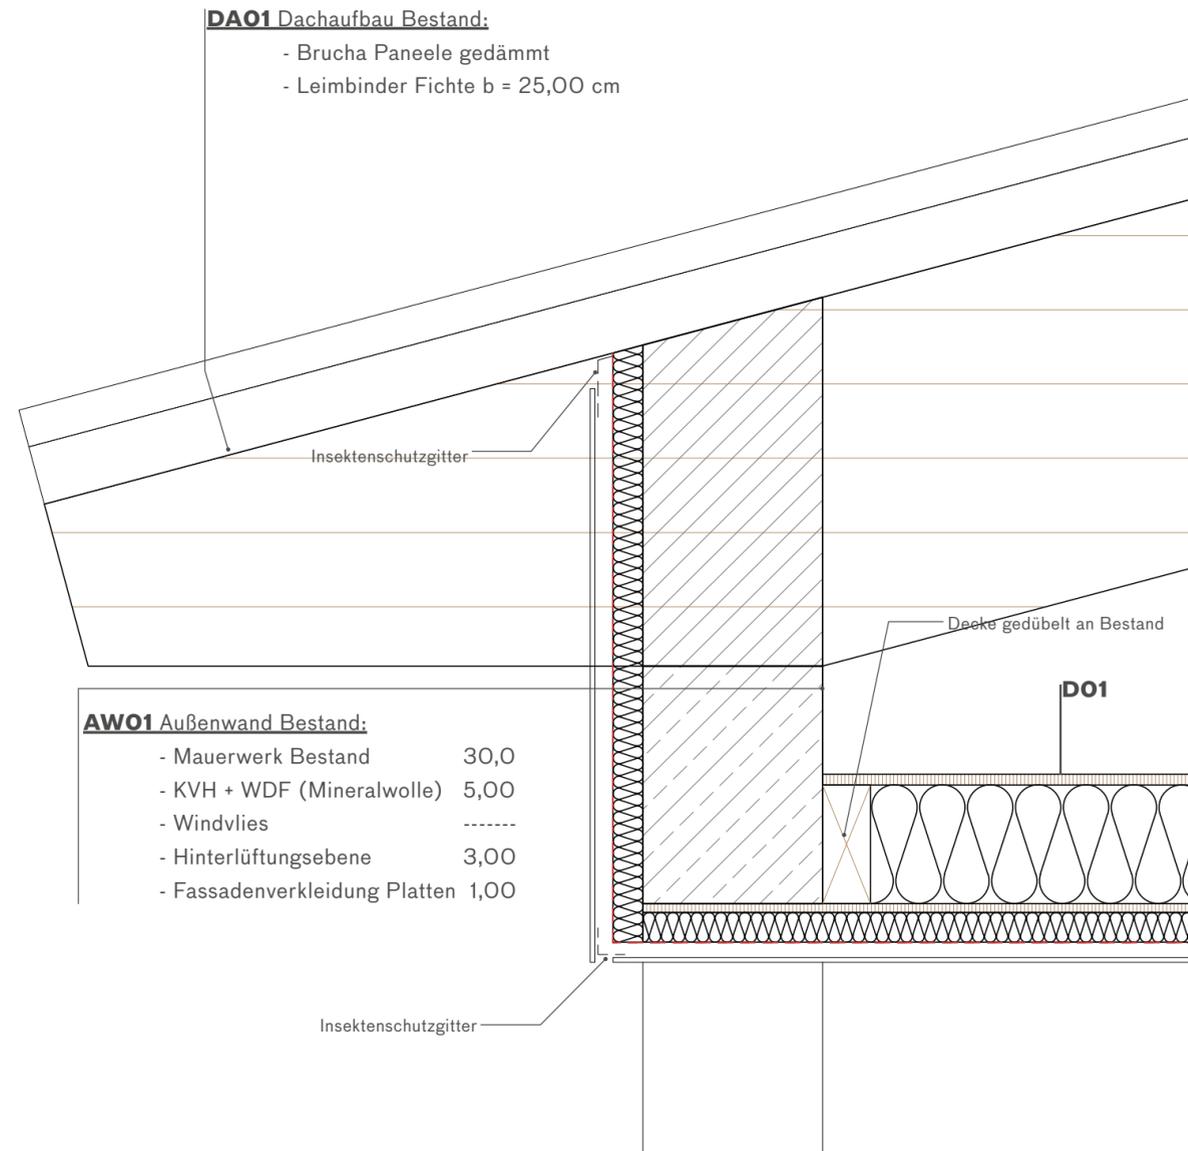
Detail hinterlüftete Fassade Umbau Bestand
